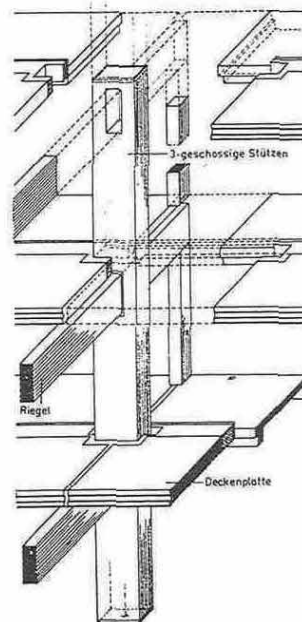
Isometrie der Stahlbetonskelettbauweise
